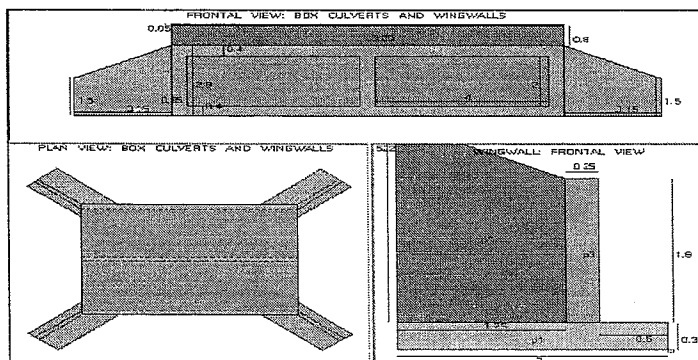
Diseño de Alcantarilla (Boxculvert)
